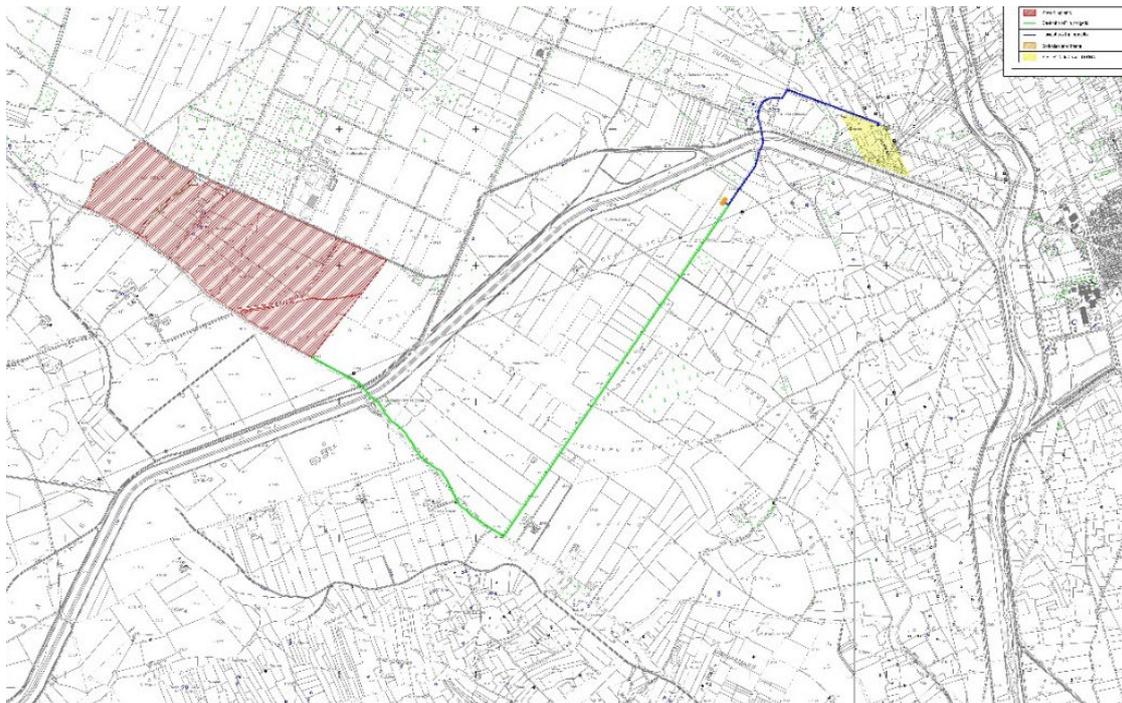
Planimetria di progetto “Saltu bia Montis” su Ctr
